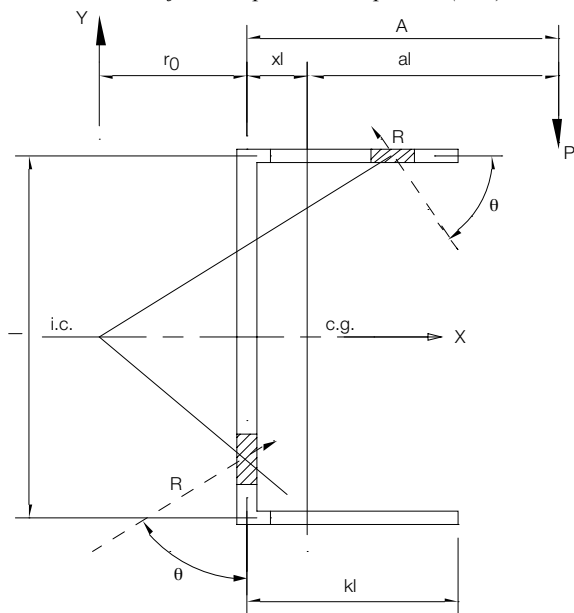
Nomenclatura del elemento de soldadura.
